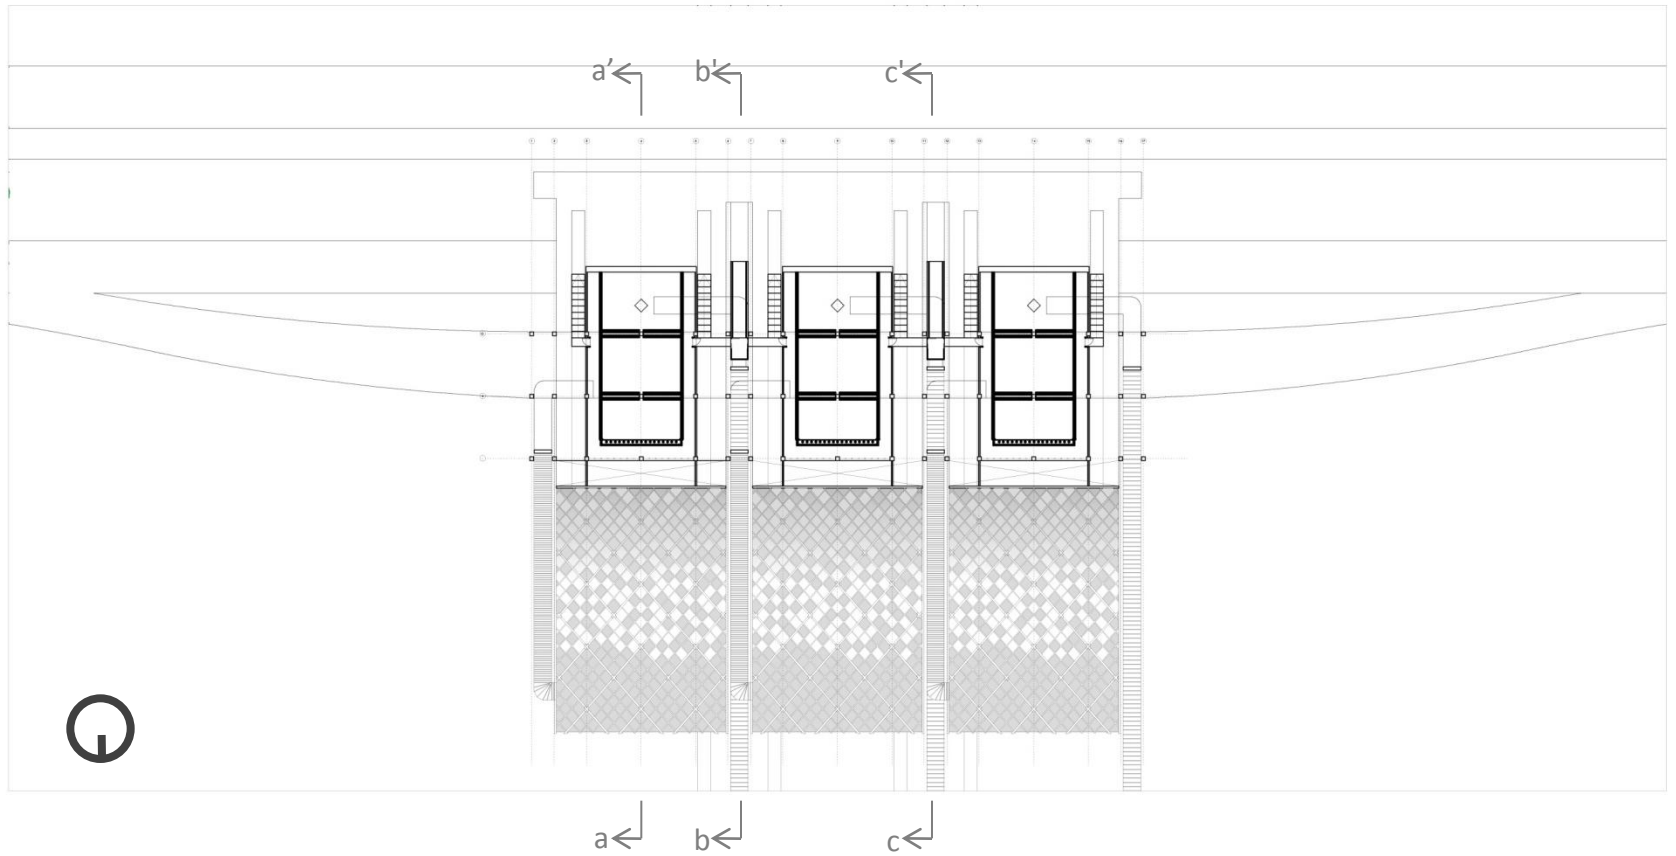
Planta nivel -2_ Salas de Materias primas esc 1:800
